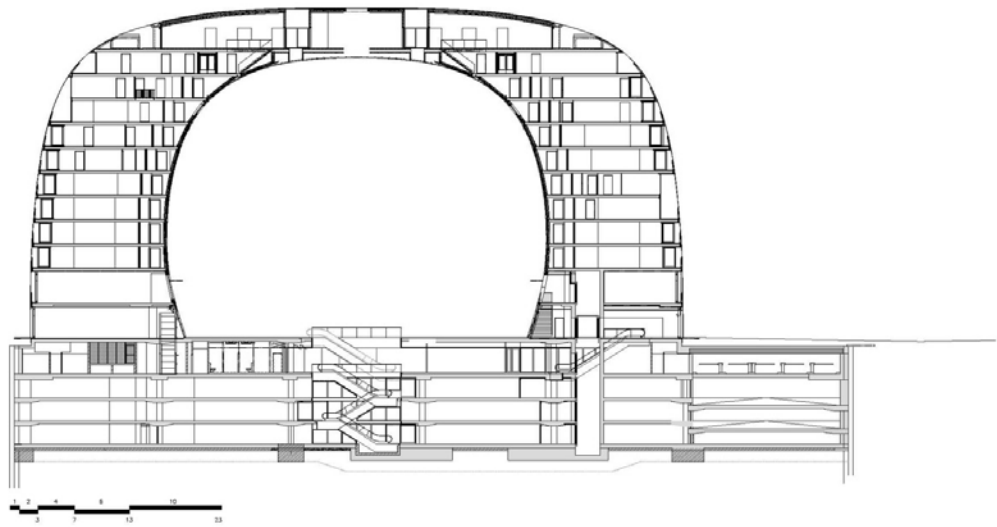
Sección. Fuente: <http://www.archdaily.co>
